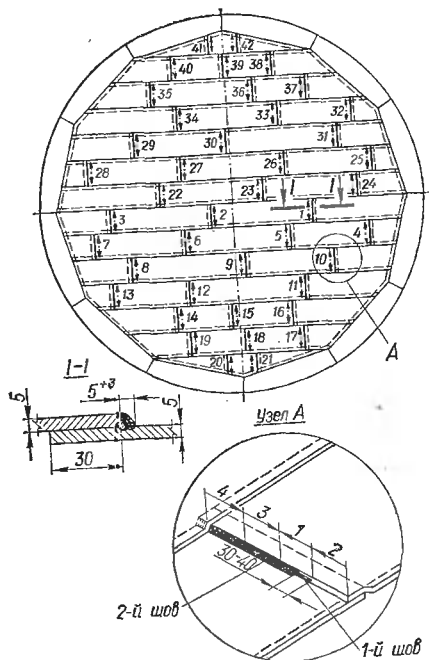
Последовательность сварки поперечных швов средней части днища (обозначена цифрами).
